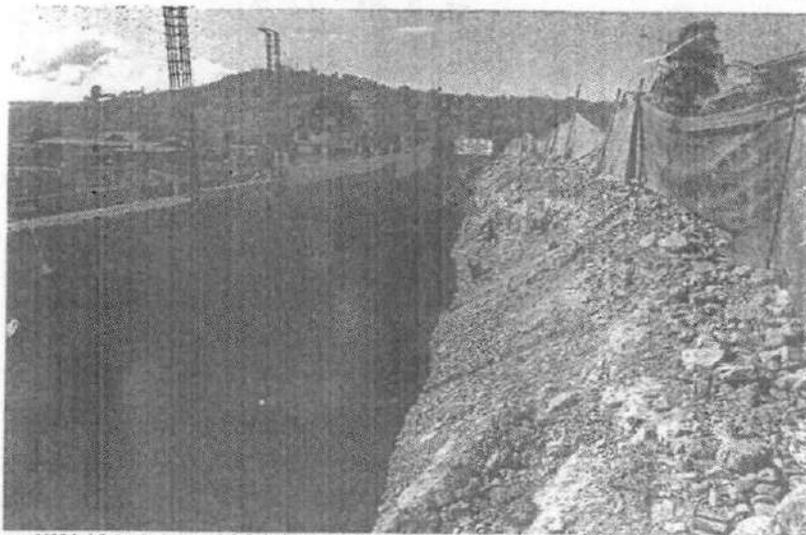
Vista de tramo 1,2,3,4. Se debe ampliar la zapata con un talón hacia la calle Aranda, e incluir contrafuertes para reforzar la pantalla del muro.
